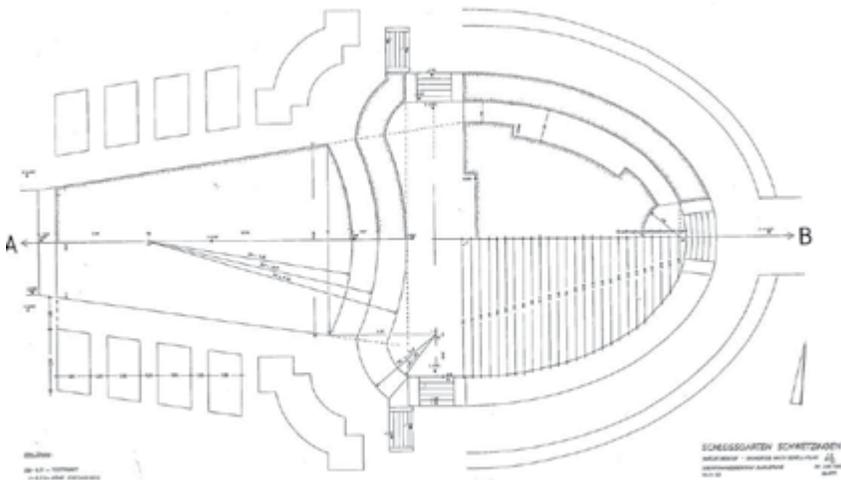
Hubert Wolfgang Wertz: Grundriss des Naturtheaters nach dem Plan von Nicolas de Pigage, 1783, und Grabungsfunden, Massstab 1:50.
